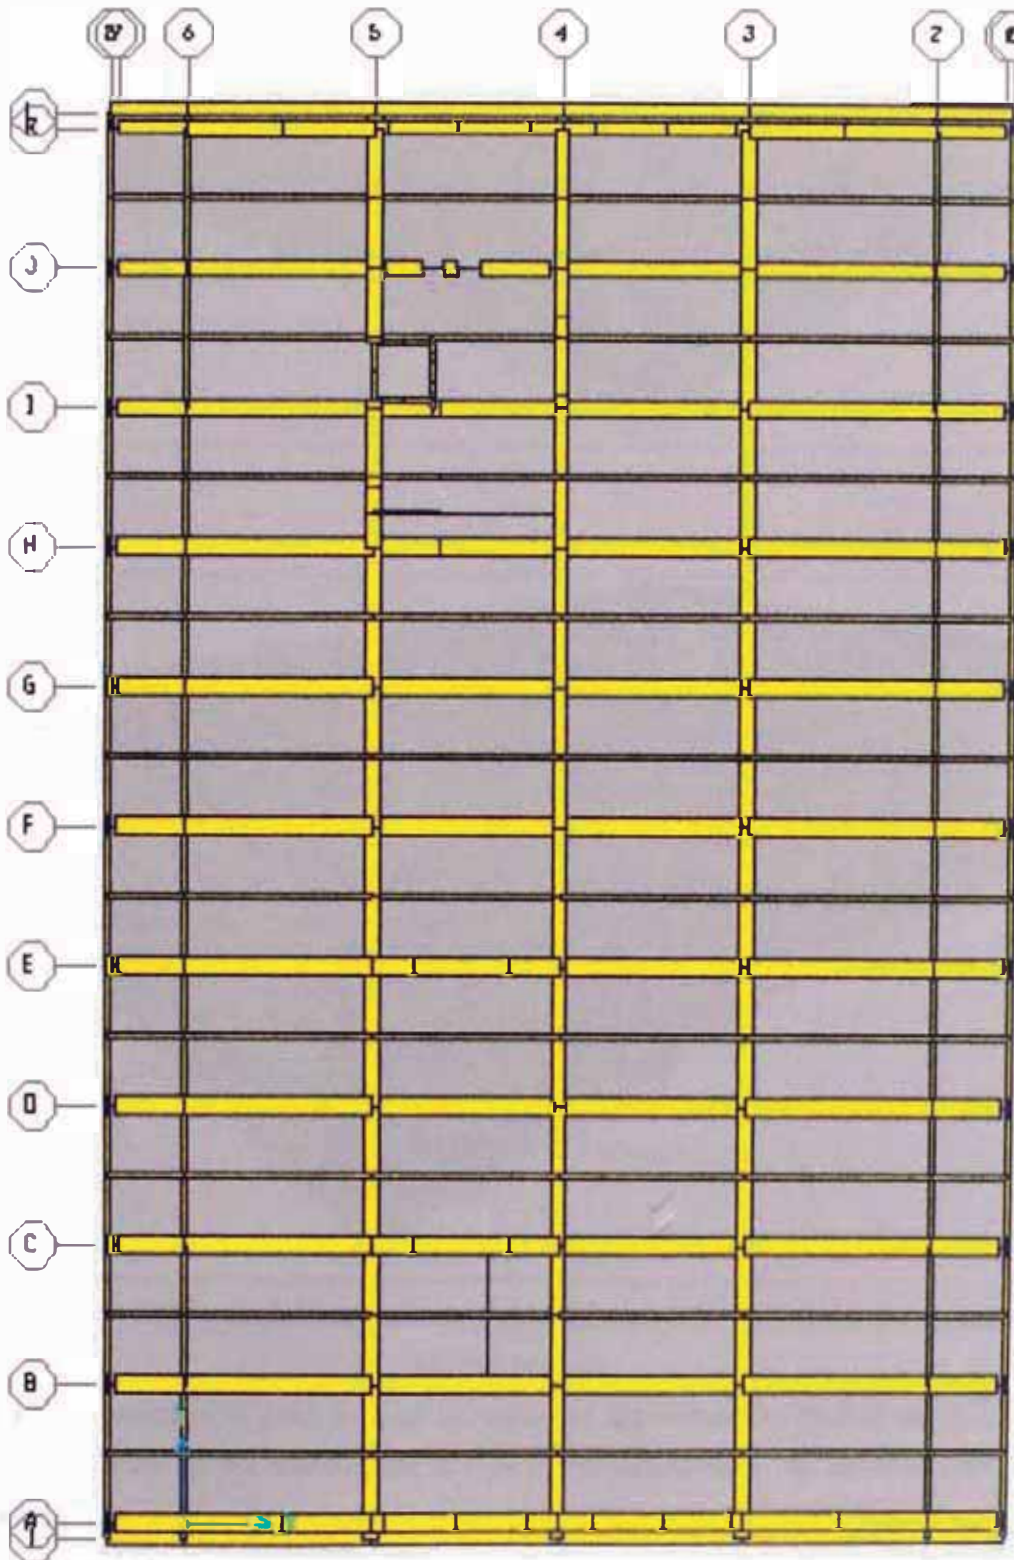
Modelo estructural de la edificación en SAP2000 (vista en Planta).
